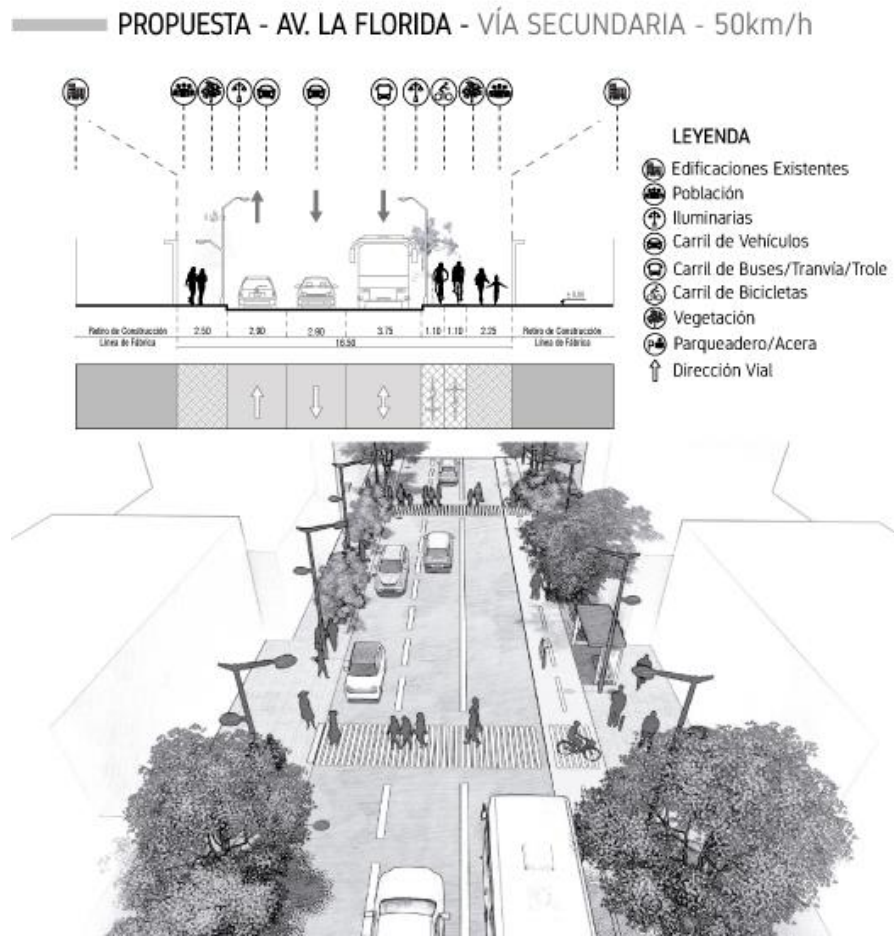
Propuesta del Plan Estratégico Urbano - Sistema de Movilidad - Reestructuración Vial – Av. La Florida. *Fuente:* (Taller Profesional, 2019-2020)
